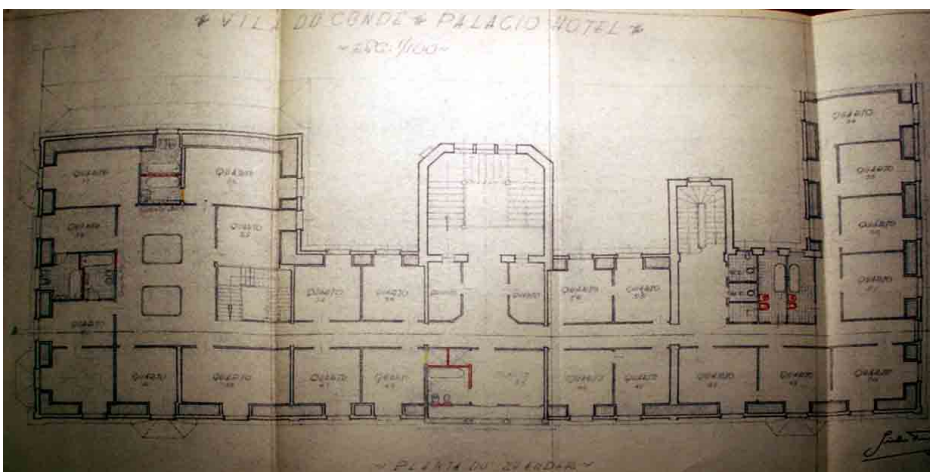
Plan pierwszego piętra w Palácio Hotel de Vila do Conde w roku 1946. Archiwum Miejskie w Vila do Conde.
